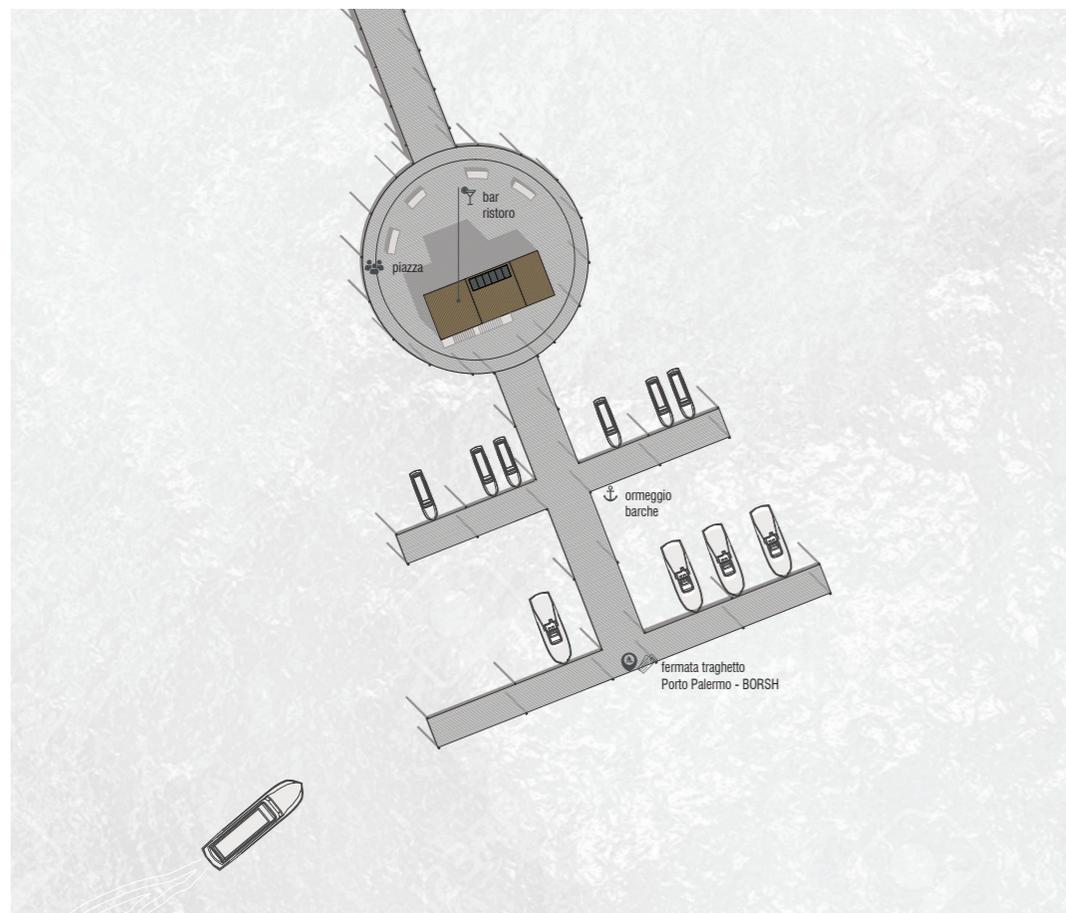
Pianta attacco a terra - sezione AA'. Scala 1:500
